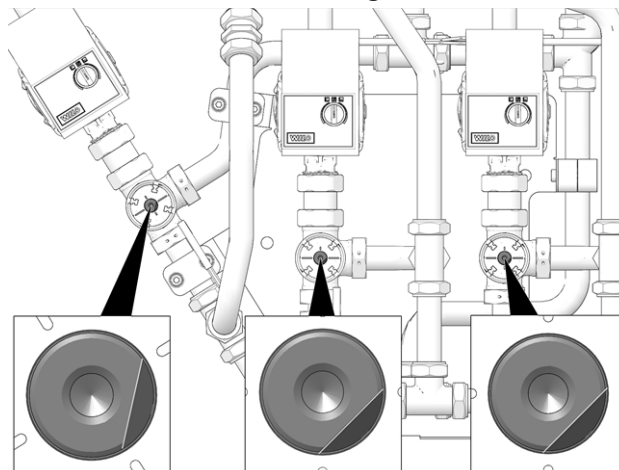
Ajuster la position de l'arbre du mélangeur
